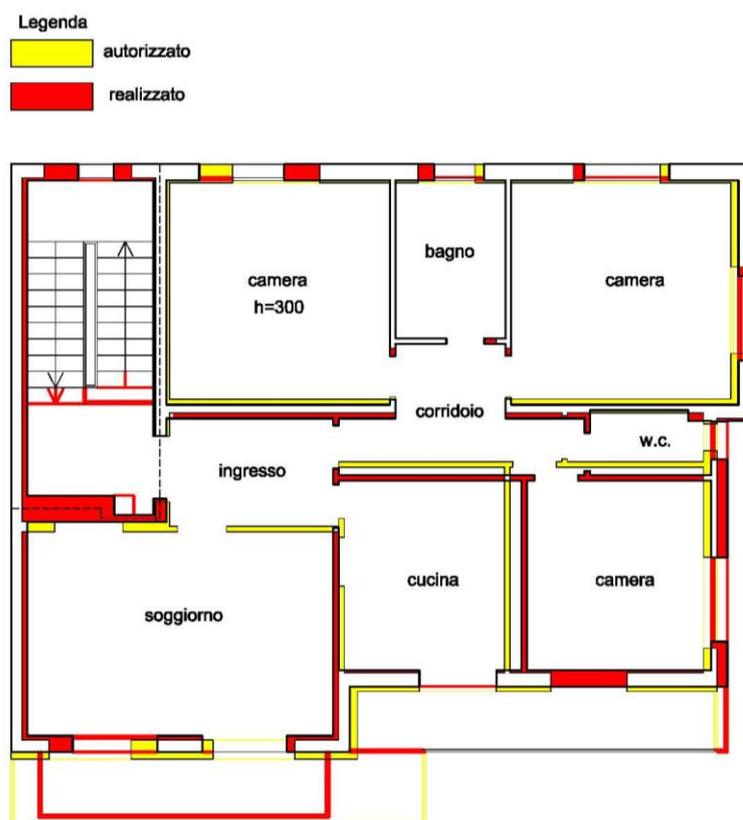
Pianta piano secondo - Sovrapposizione tra progetto approvato e stato rilevato ([Allegato 10](#))
